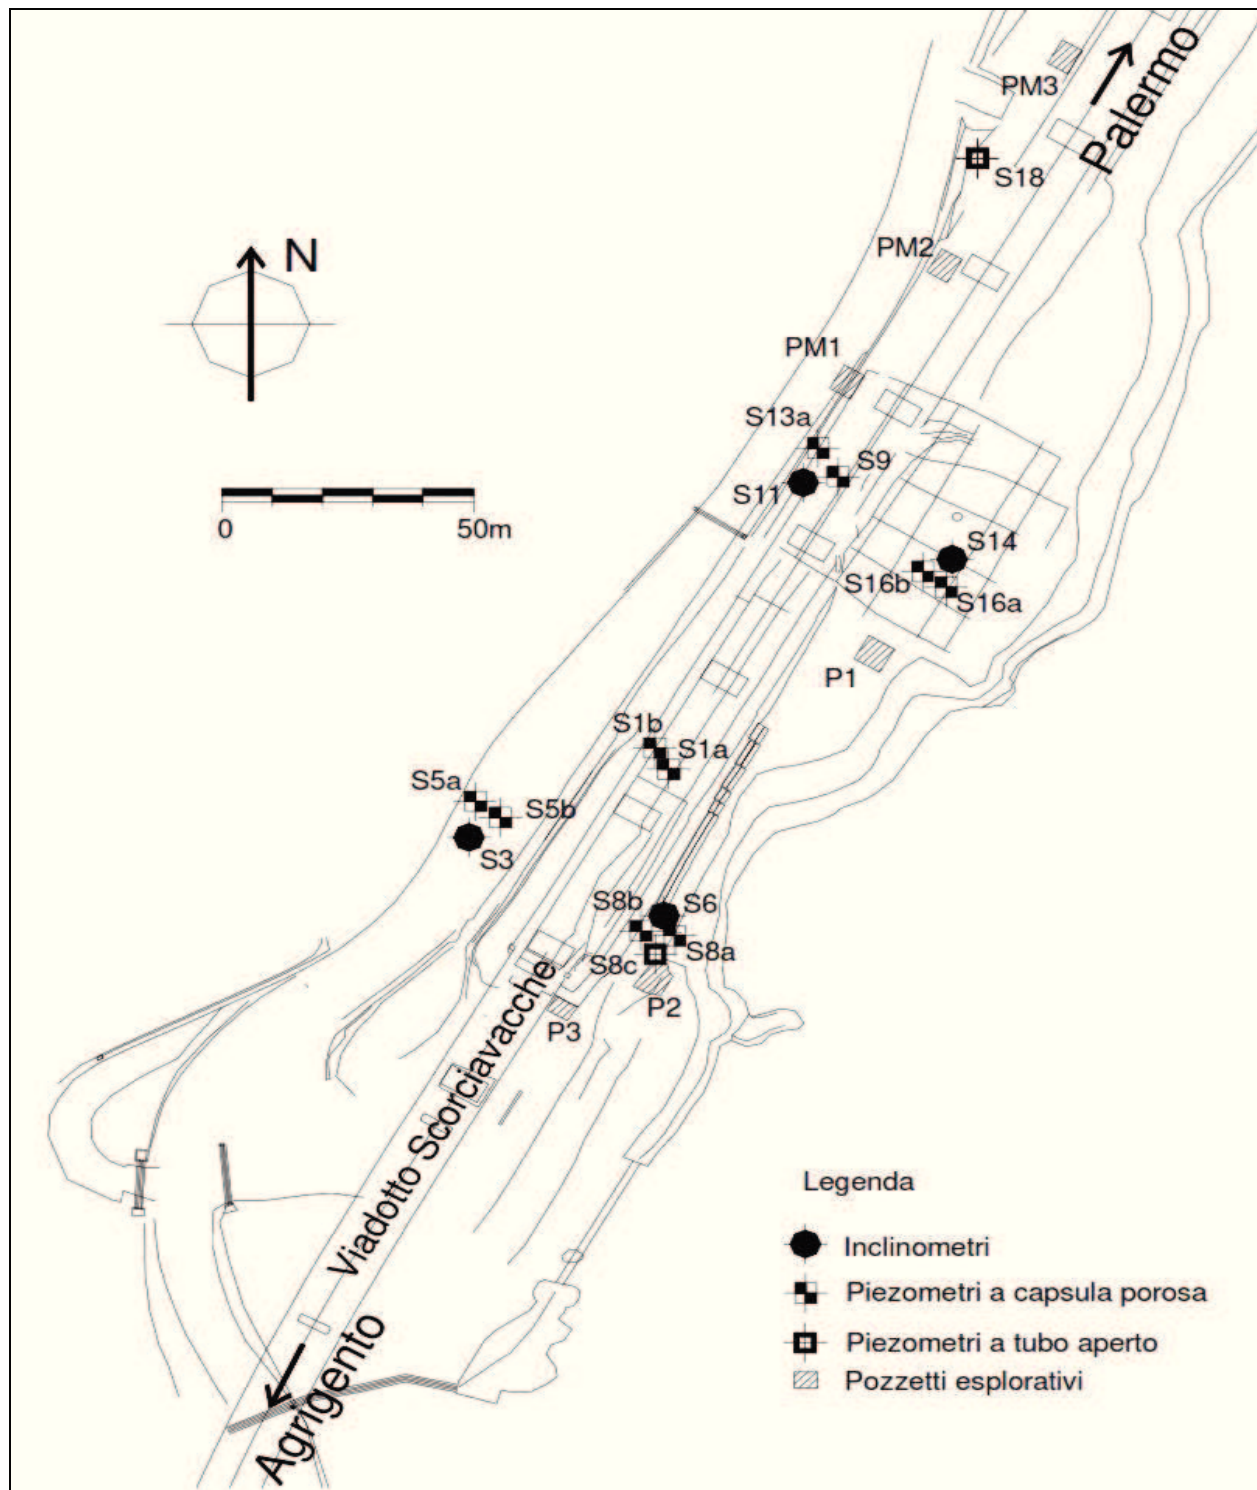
Schema planimetrico con ubicazione dei piezometri installati nell'ambito delle indagini svolte per la CTU (tratto da CTU, Appendice G.9/5 - DICAM - Rapporto Misure geotecniche in sito).
